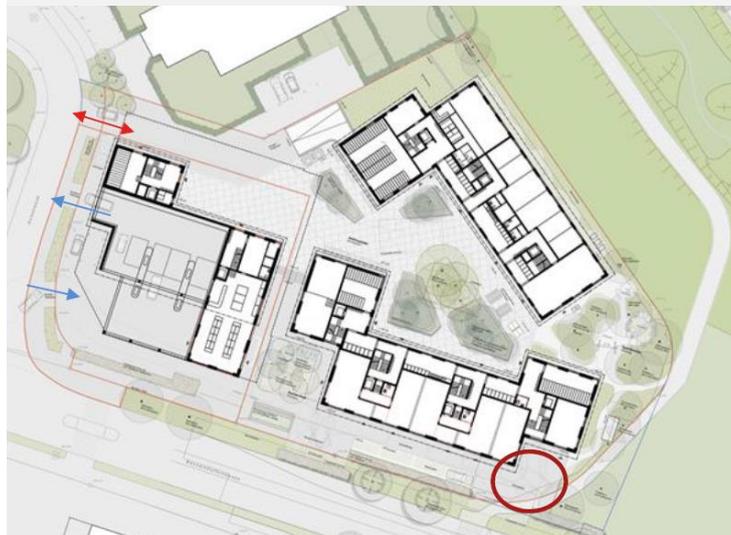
Planausschnitt Umgebungsgestaltung (blaue Pfeile=Ein- und Ausfahrt Tankstelle / Anlieferung / Kunden- und Besucher-Parkplätze / rote Pfeile= Ein- und Ausfahrt Einstellhalle Sektor C4, dunkelroter Kreis= Wendemöglichkeit)
